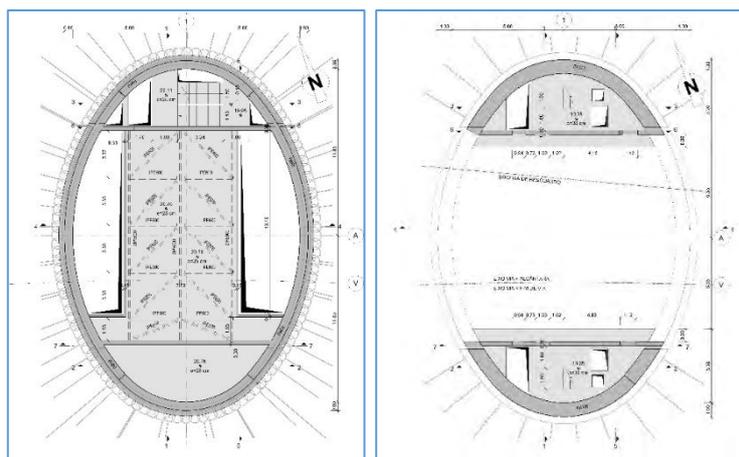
Plantas tipo da estrutura definitiva do poço.
